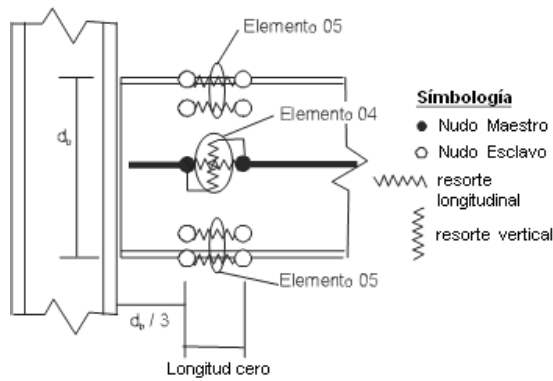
Intersección Viga – Columna del Pórtico Prototipo.
